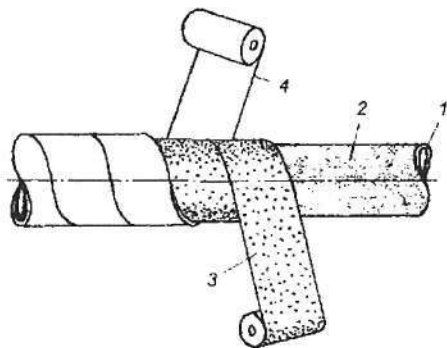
Формирование на трубопроводе покрытия на основе липких полимерных лент: 1 – стальной трубопровод; 2 – слой грунтовки; 3 – барьерное покрытие; 4 – защитный слой
